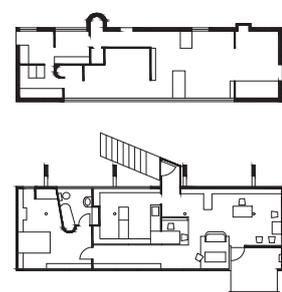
| Planta da Petit Maison e planta da Casa sobre o Mar.
